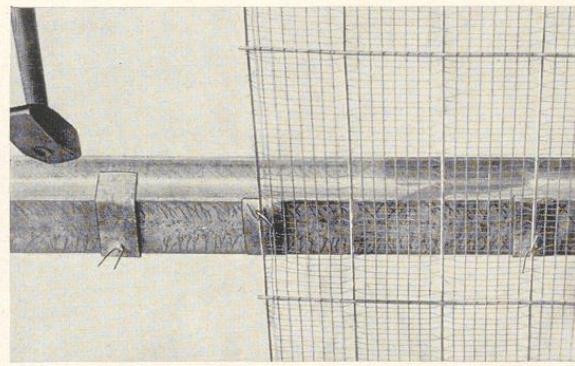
Befestigen der Baustahlmatten an eisernen Trägern
